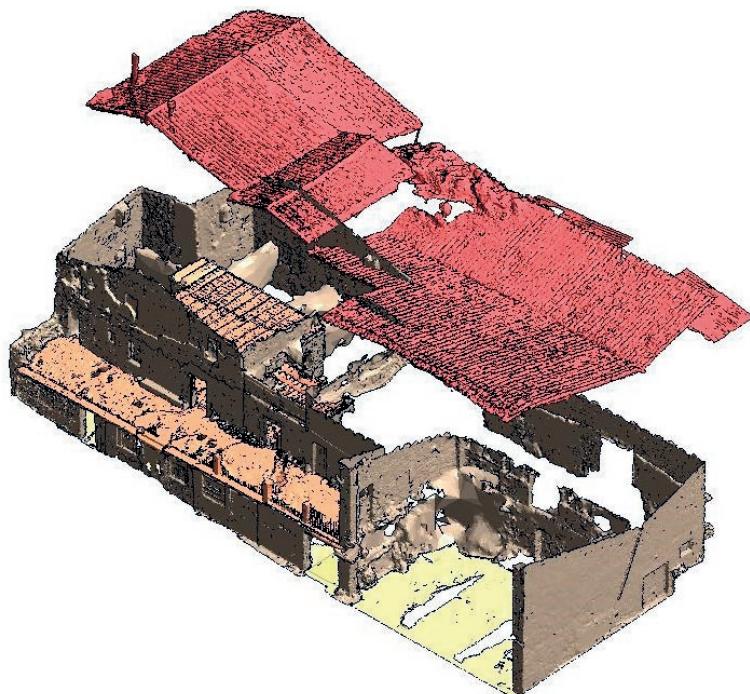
Mallado por sistemas constructivos en BIM del levantamiento volumétrico de Mas Maçandell.
